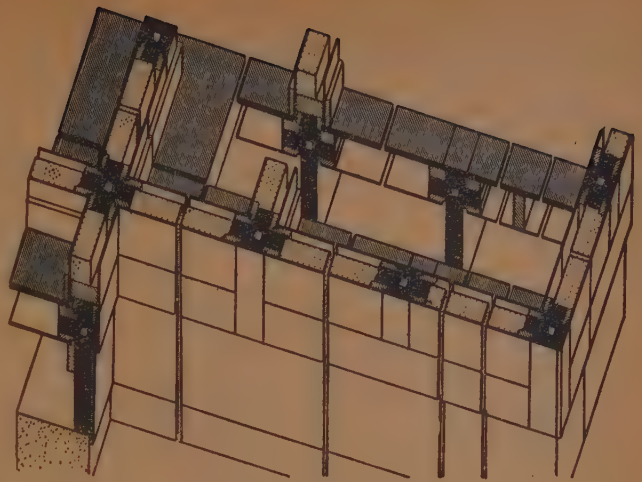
oben und 27 unten: USA: Konstruktionsdetails der Montagebauweise für Siedlungsbäuser
